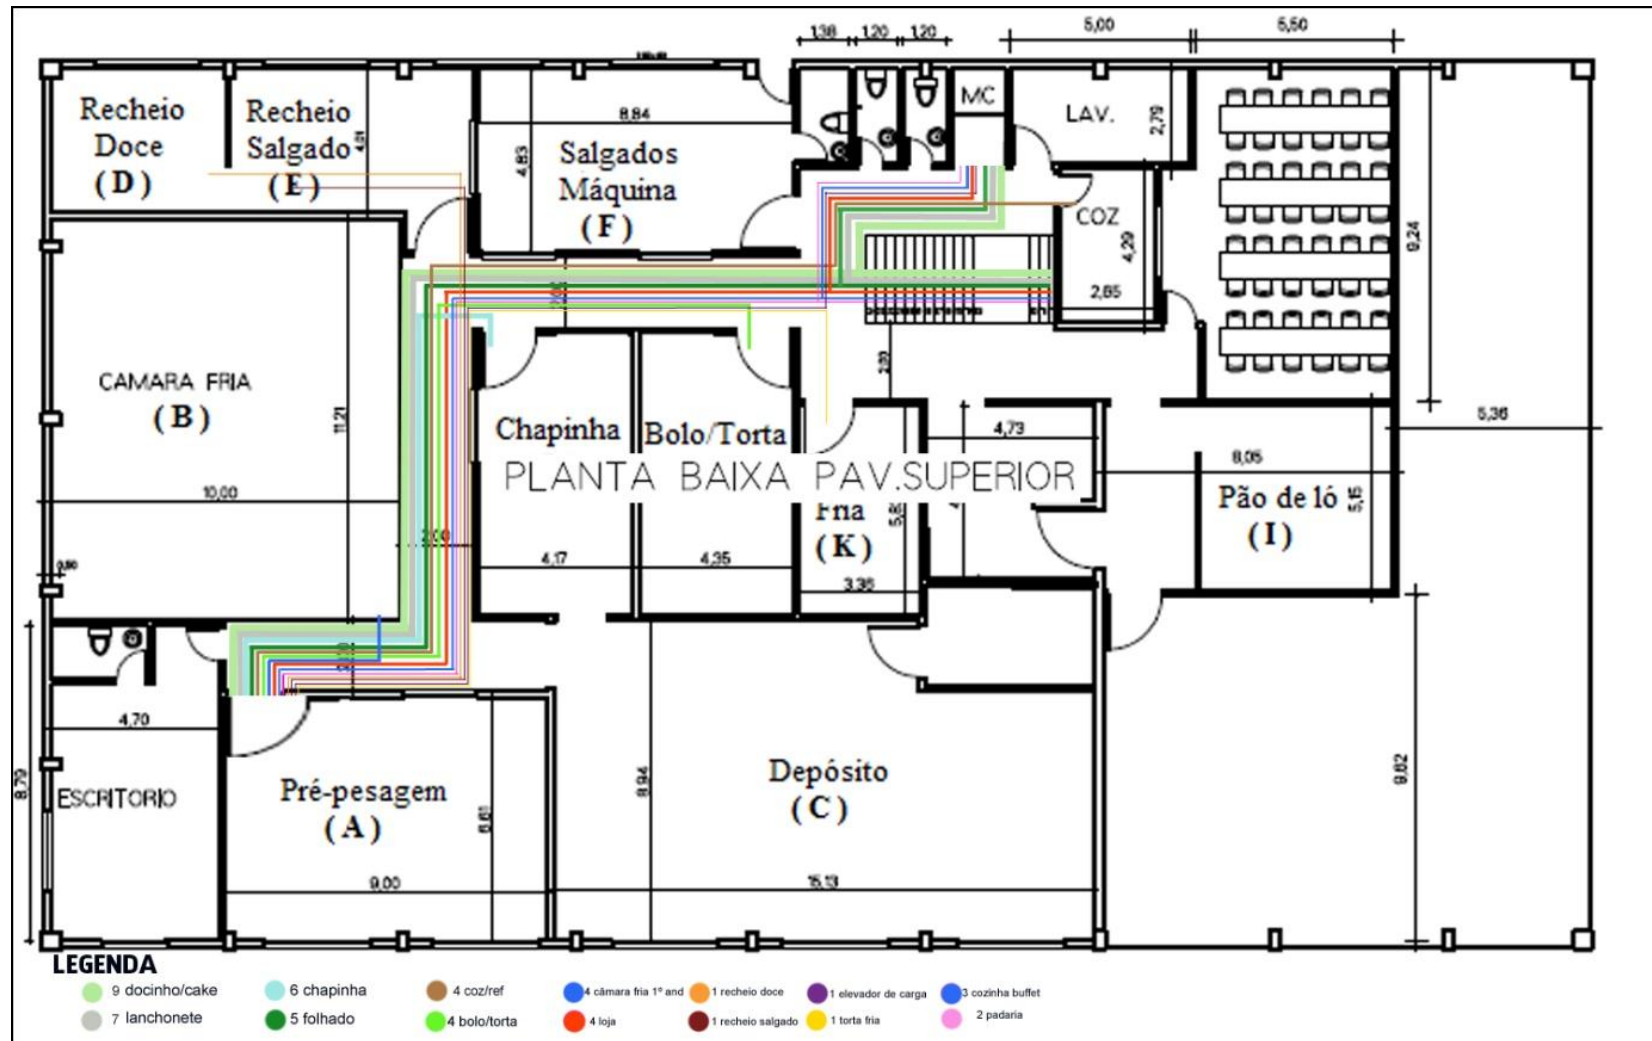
Diagrama Spaghetti planta baixa pavimento superior
